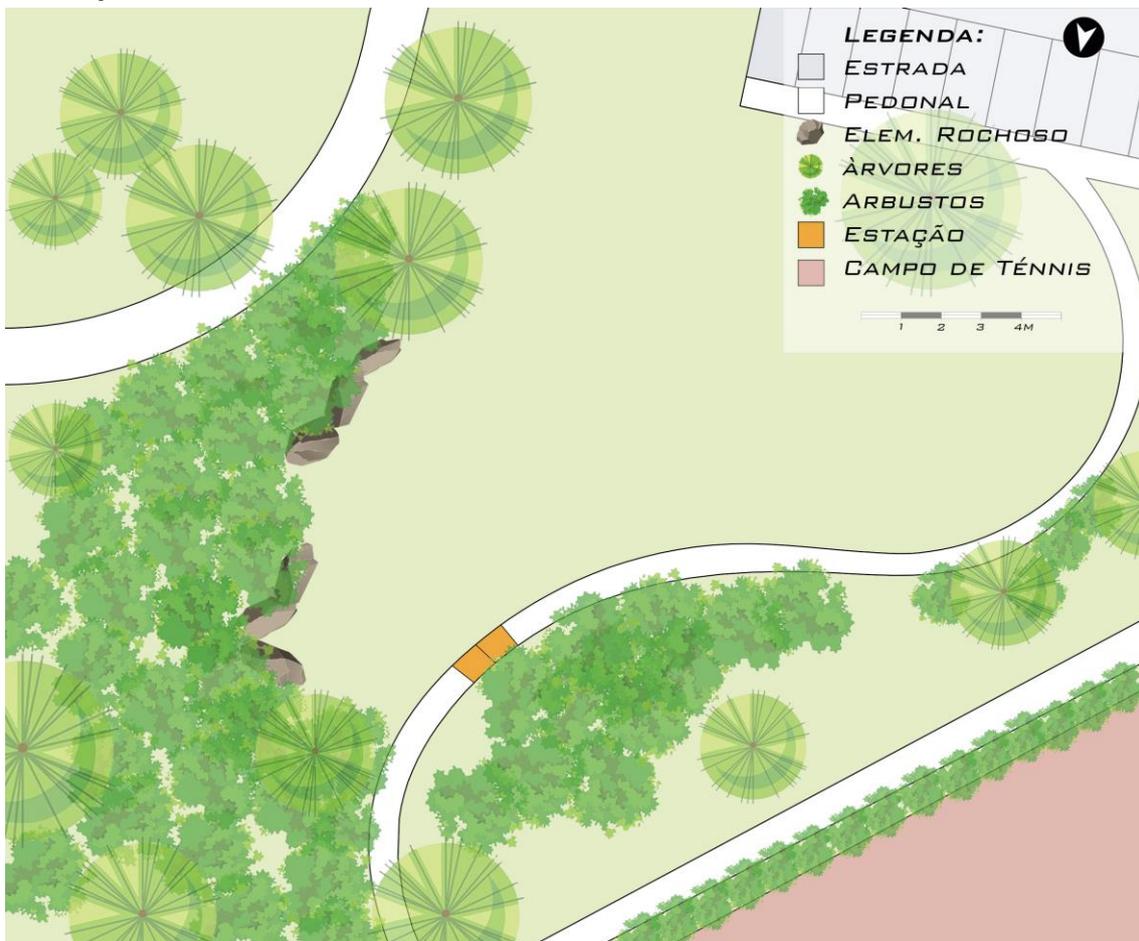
Planta da estação E11, Azul Cristal e Amarelo Real
